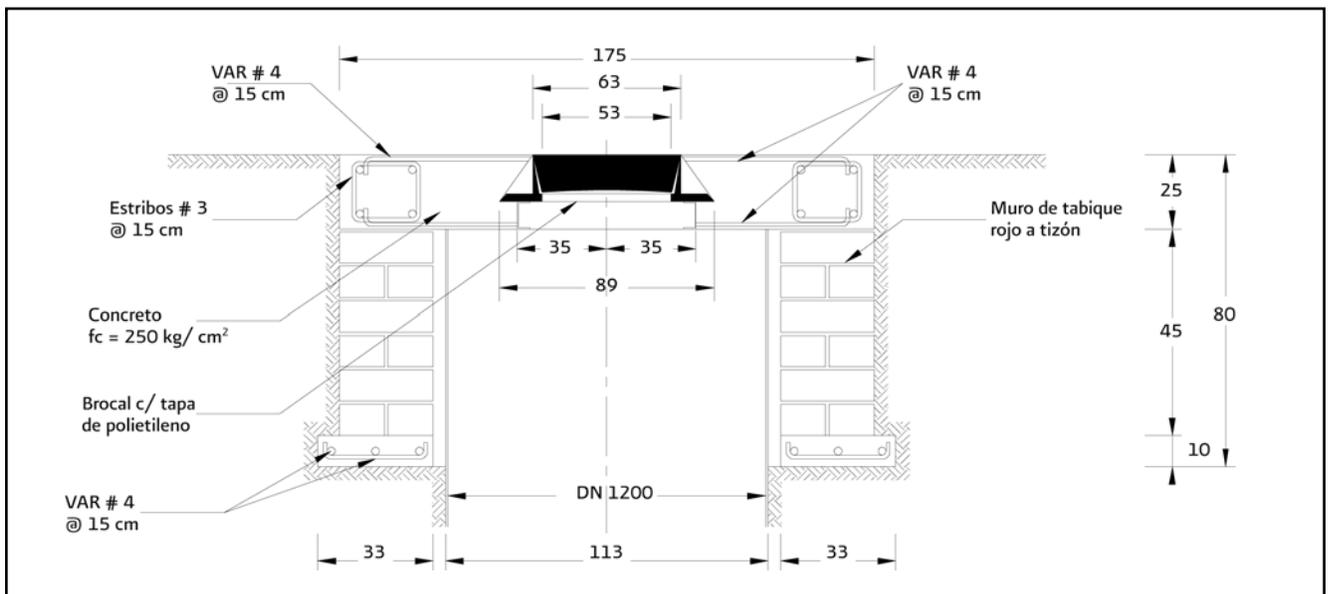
Detalle losa tapa para pozo de visita de PRFV
